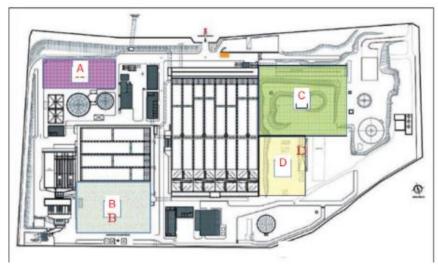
LOCALIZZAZIONE AREE DI CANTIERE
